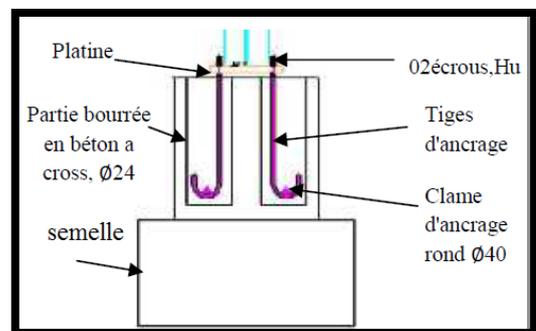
Détails 1 Articulation pied de poteau-fondation
